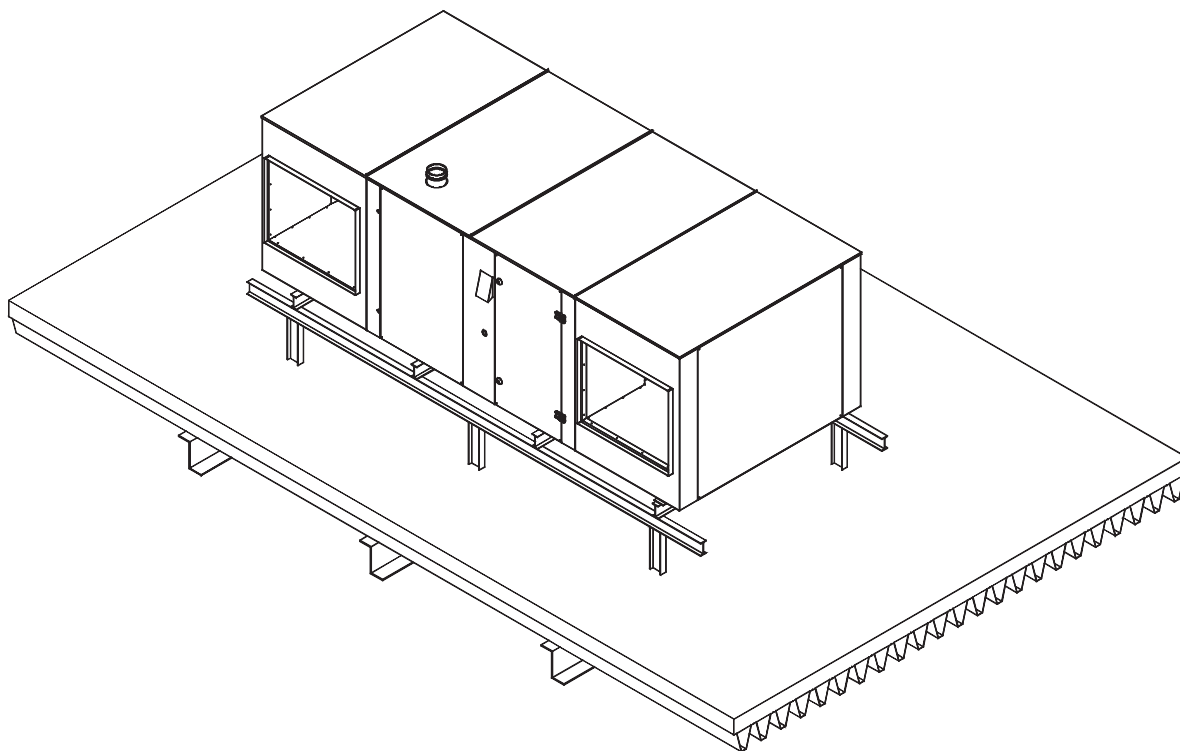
Пример установки нагревателя roof-top на поверхности крыши
